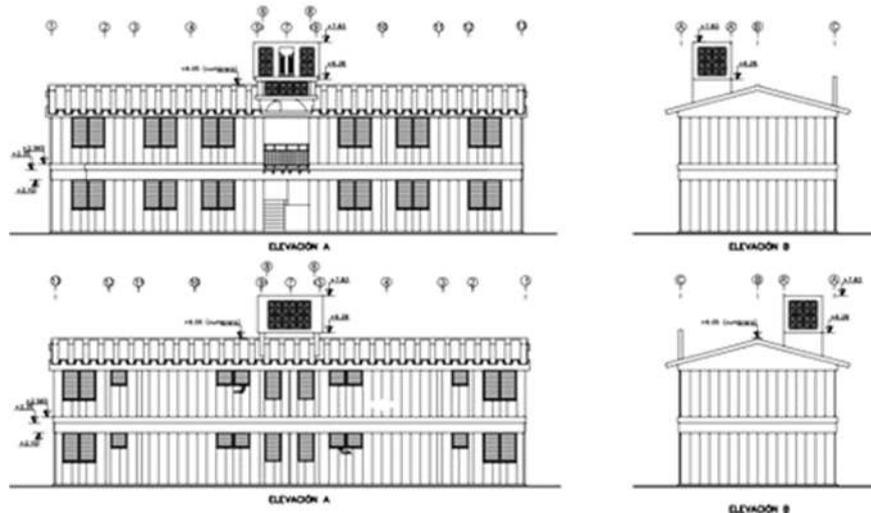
Elevaciones principales del bloque de cuatro viviendas económicas de tres habitaciones cada una. Edificación de dos niveles proyectada empleando el sistema constructivo SERF.
